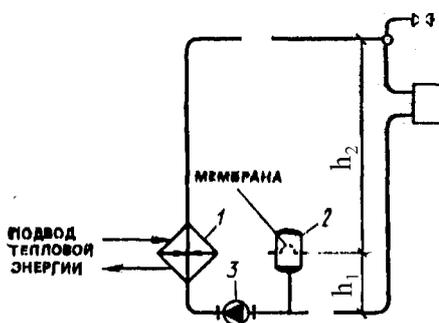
18. Схема присоединения закрытого расширительного бака
